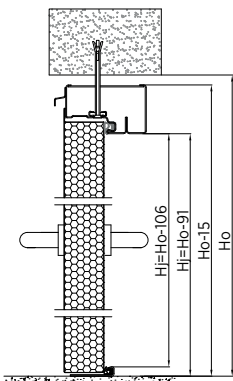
Pose au mur – porte à un vantail – bâti intérieur à rupture de pont thermique – coupe verticale
